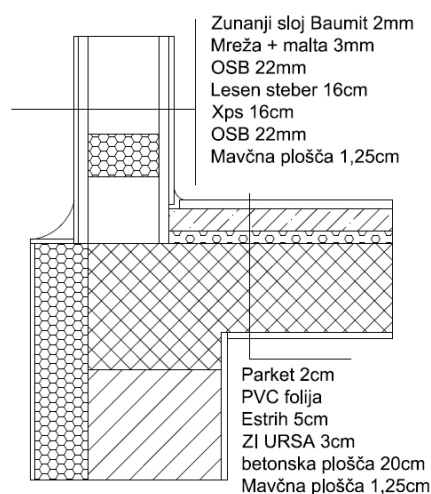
Detajl križanja konstrukcijskih sklopov stena-medetažna plošča opečna konstrukcija.
